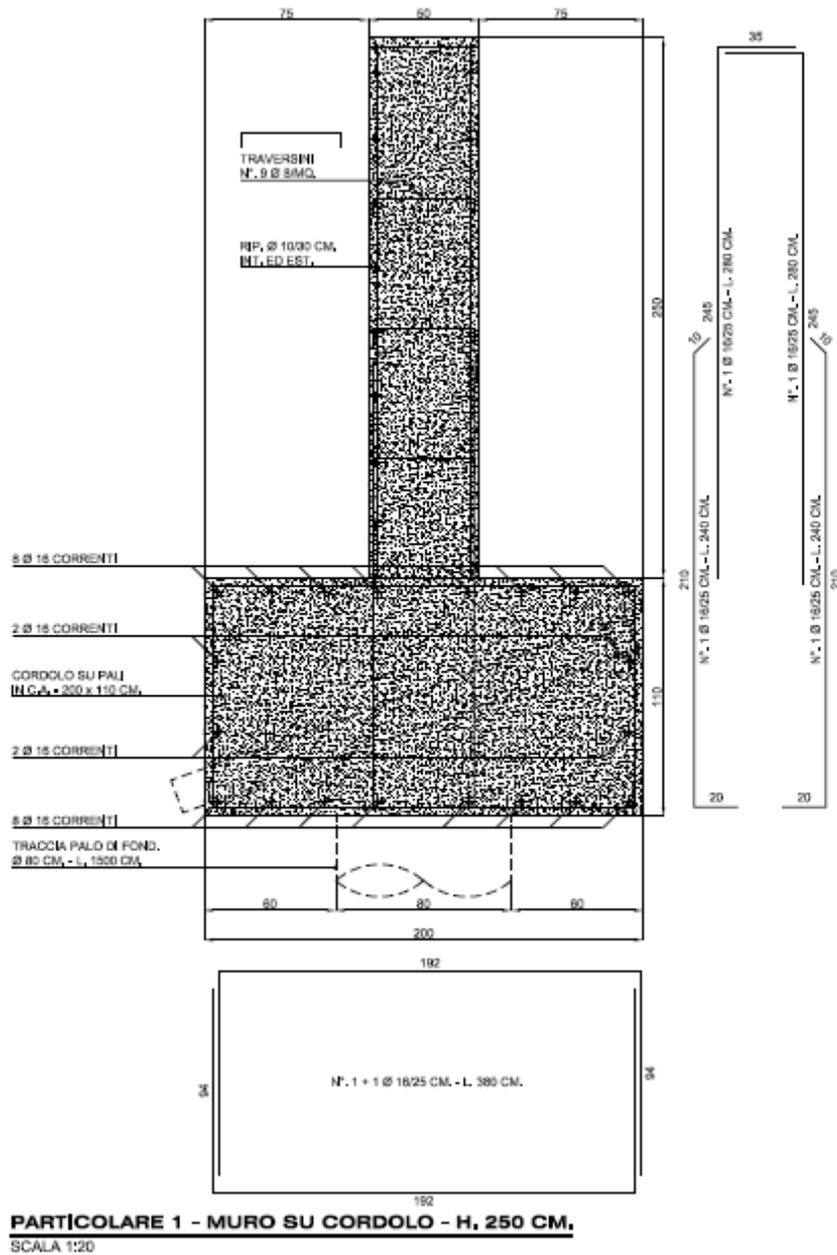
Sezione tipo del cordolo di collegamento dei pali con la parete del muro di sostegno
